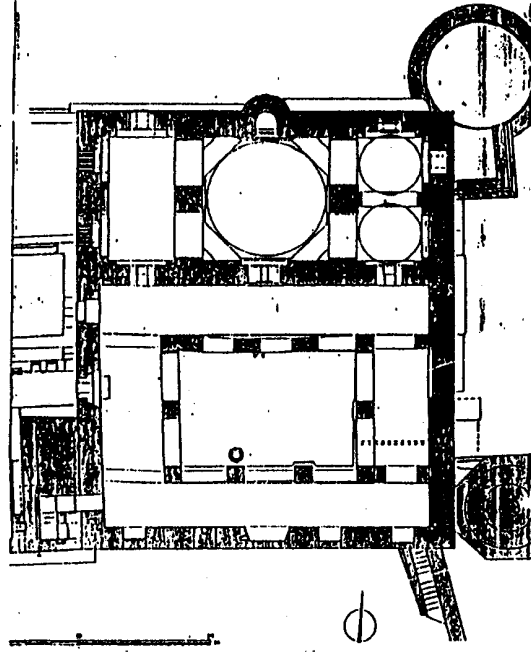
مسقط أفقي لجامع زال محمود باشا باستانبول
